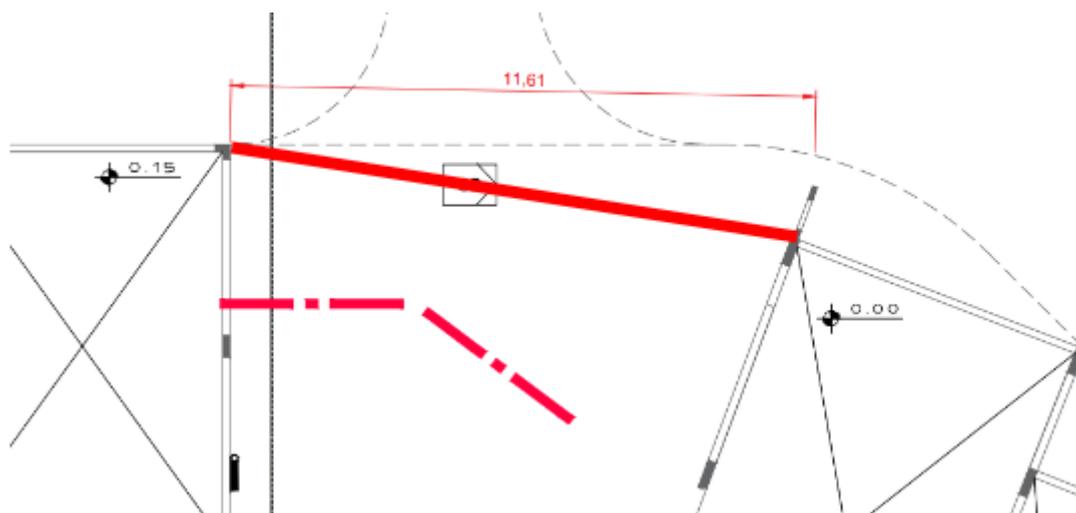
Localização das vigas baldrame (vão de acesso ao subsolo sob rampa principal).
